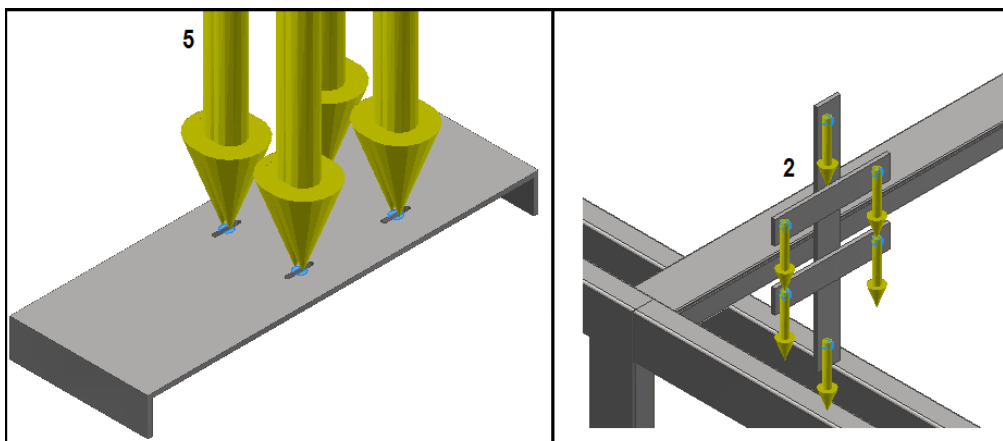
Pormenor das cargas aplicadas na estrutura (a)
